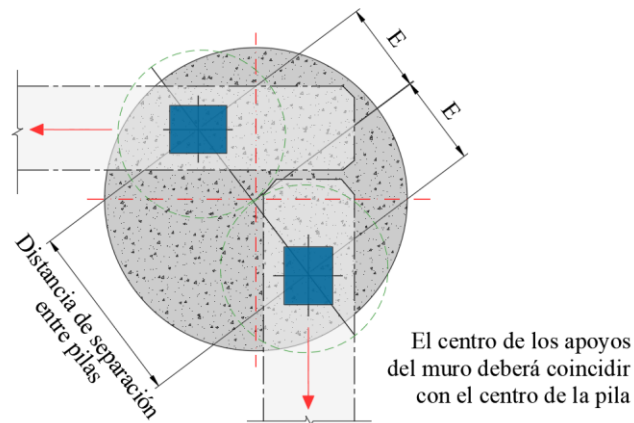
b - Posición de los apoyos de los Muros Tilt-Up en esquina con referencia a las pilas
